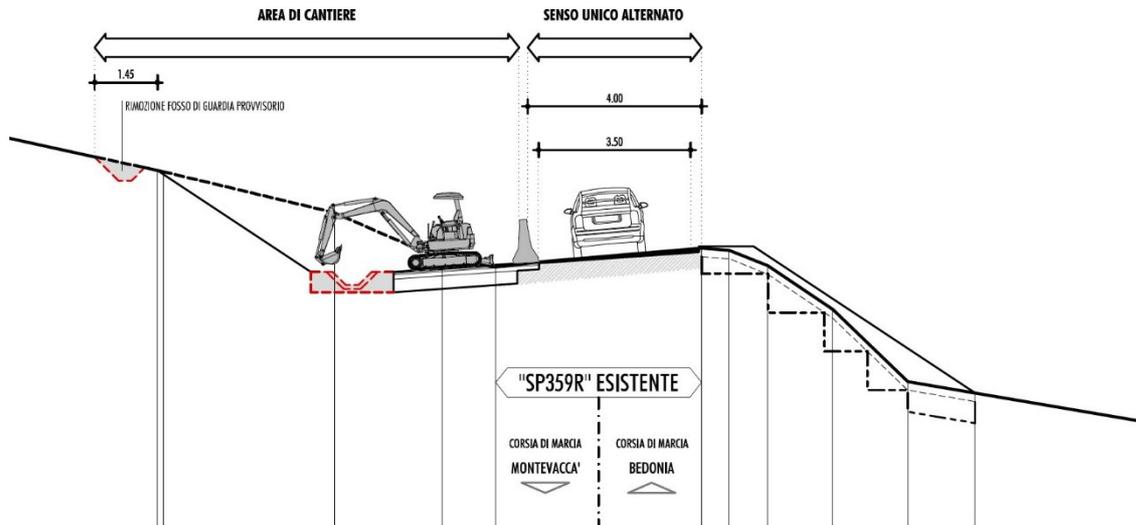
TRATTO 3, FASE 3: TRAFFICO SU CORSIA DI MONTE (ESTRATTO DALL'ELAB. PD.04.04)
